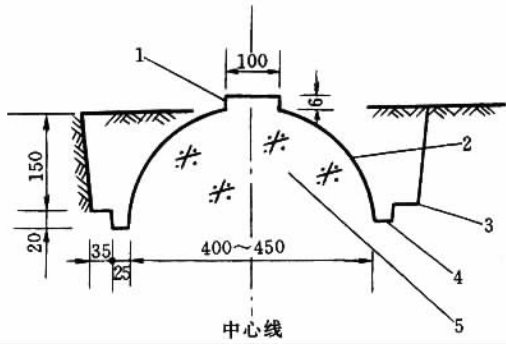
混凝土窖盖半球状示意图 (单位: cm)
